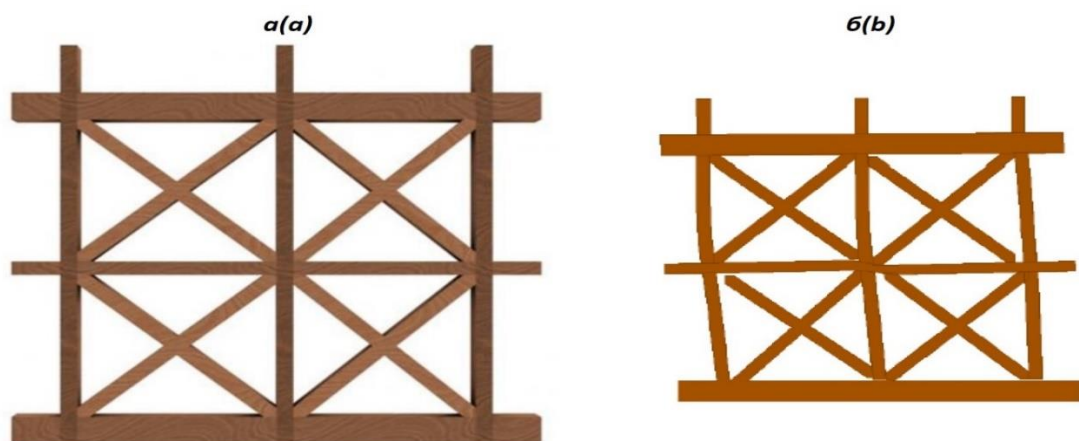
Деревянная рама стены в конструктивной системе «Помбалино»: а – до испытаний; б – поведение стены во время испытаний
